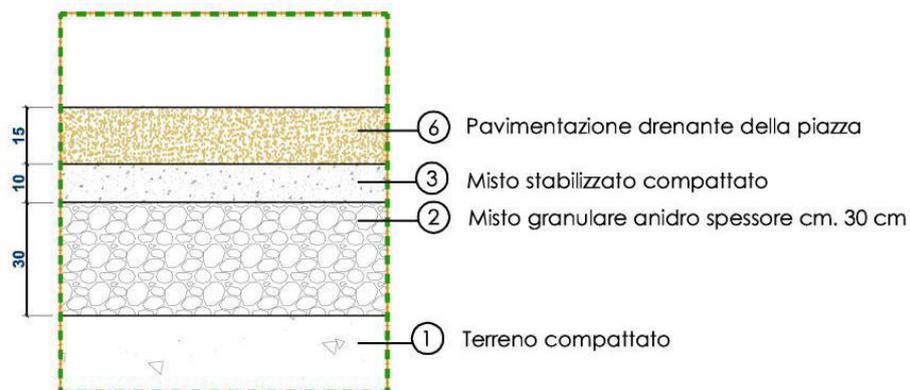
Particolare costruttivo della sistemazione della piazza pavimentata
